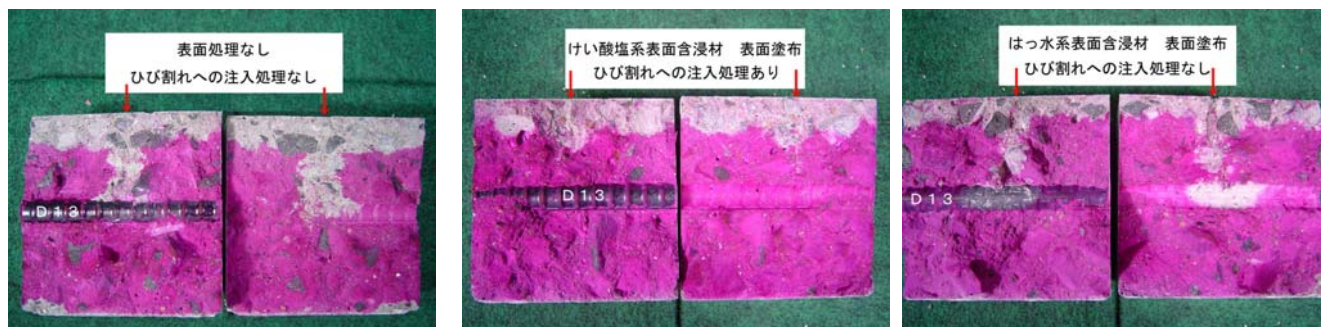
中性化領域写真(白色領域：中性化領域，赤矢印：ひび割れ発生位置)
